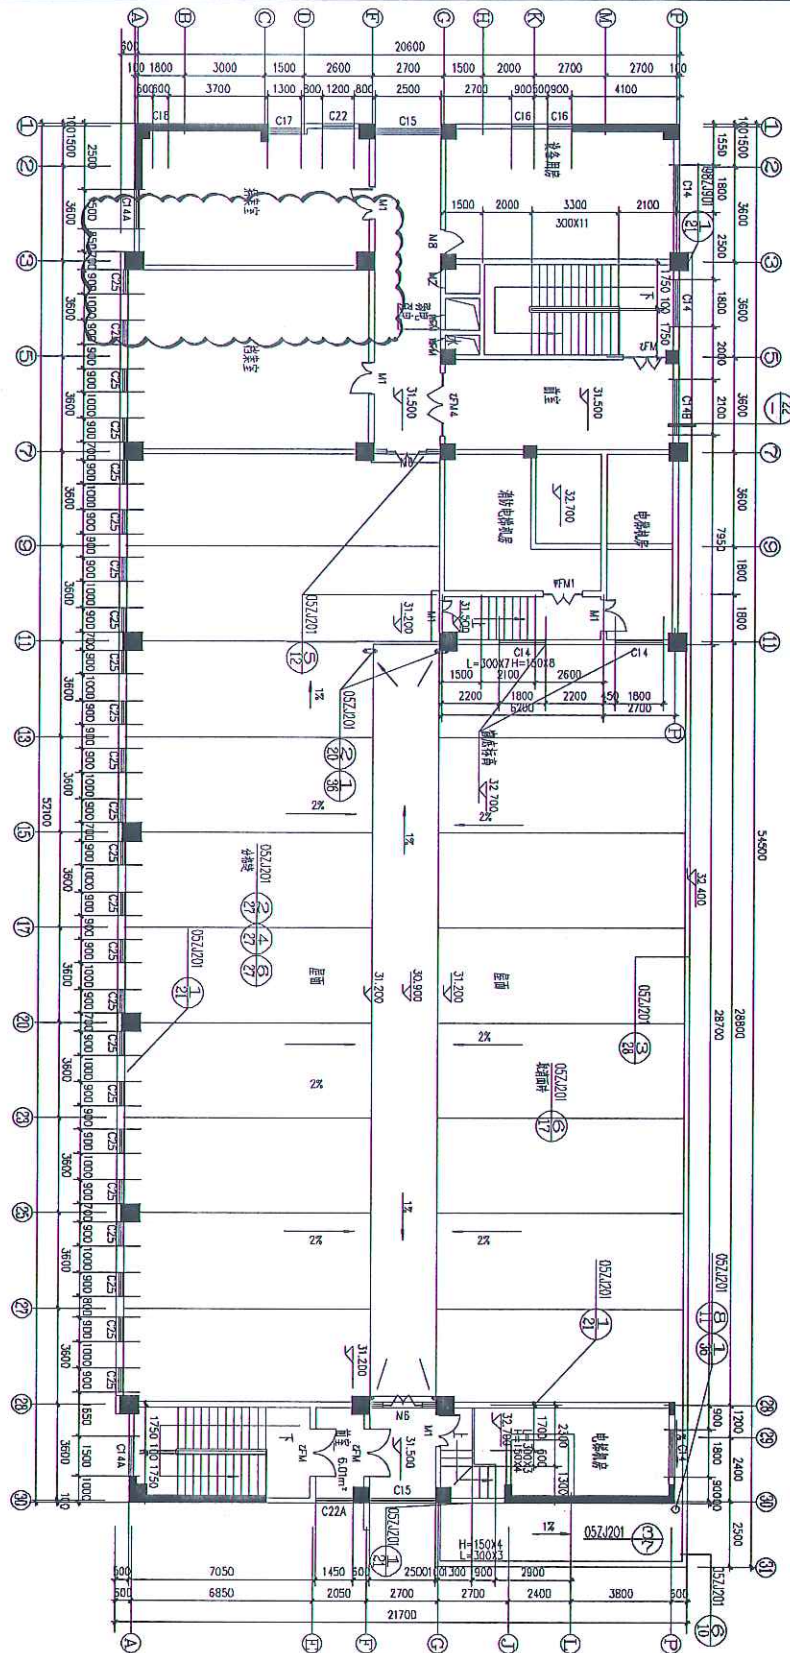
10 层改造设计平面布置图(云线范围为装修改造区域)
